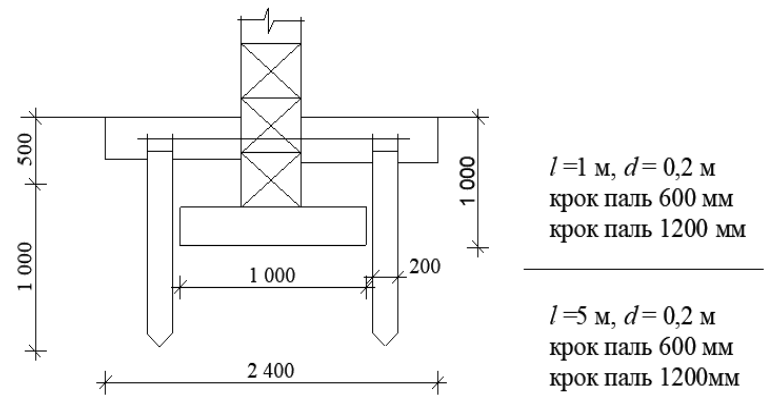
Модель підсилення фундаменту з рівня поверхні ґрунту
